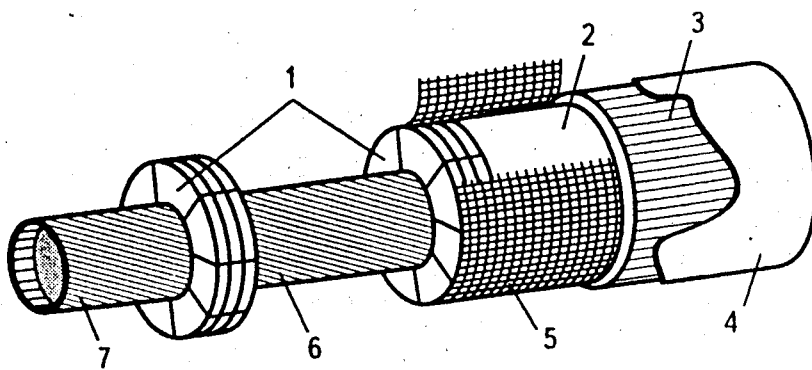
Конструкция изоляции, выполненная набивкой под сетку:
